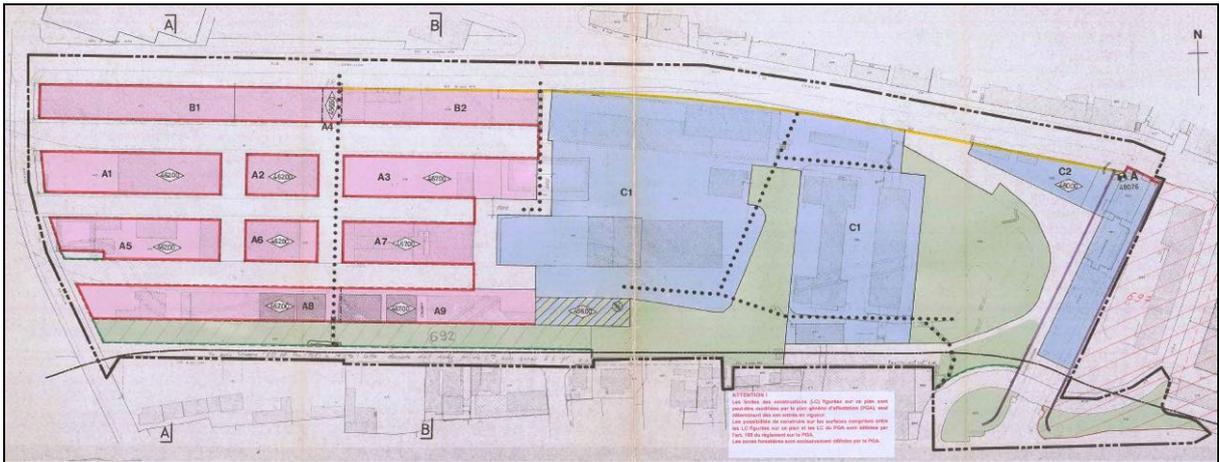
Extrait du plan d'extension [PE n° 633, 1988]
